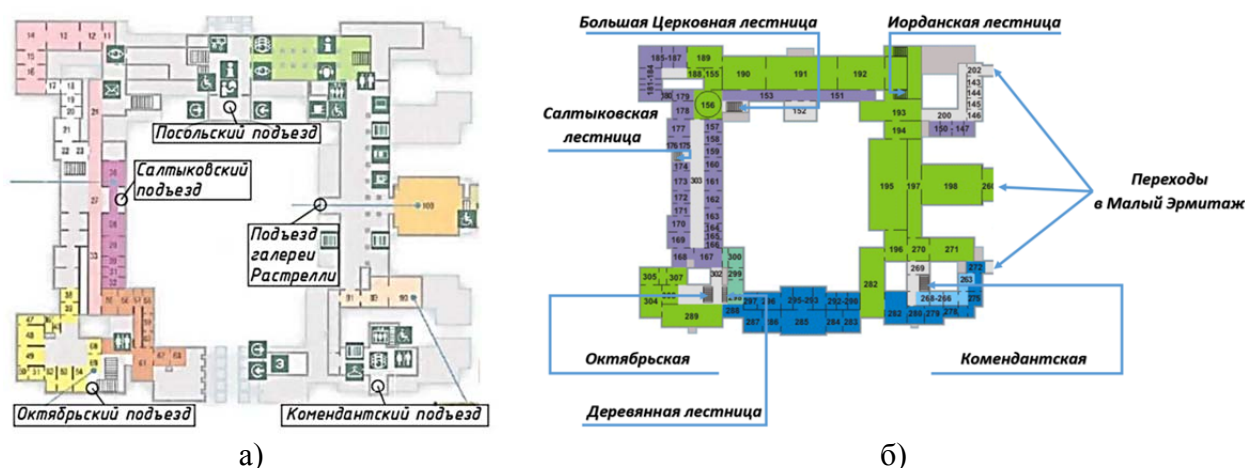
Эвакуационные лестницы и выходы в Зимнем дворце: а) эвакуационные выходы наружу на плане первого этажа; б) распределение лестниц по зданию на плане второго этажа
